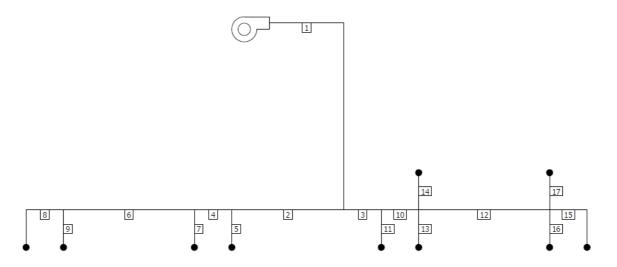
Distribución ramales Planta Tipo CL E-O
